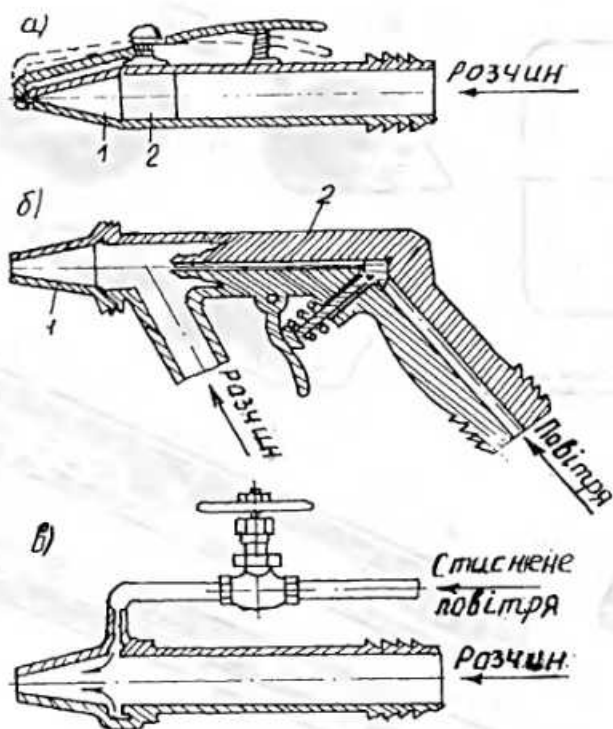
Форсунки для розпилювання штукатурного розчину: а) механічного; б, в - пневматичного; 1 - змінний наконечник; 2 - корпус
